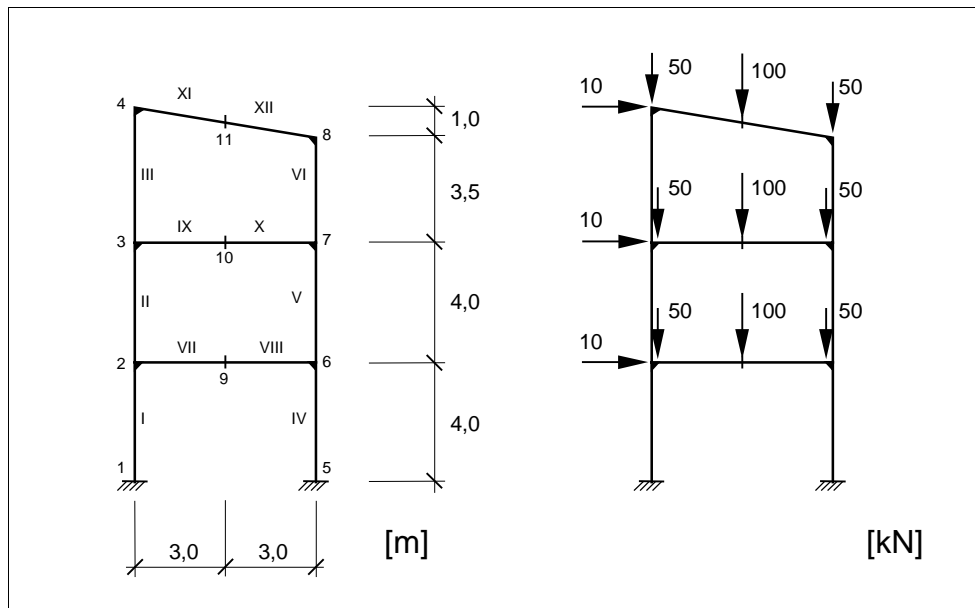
Stahlbetonrahmen – statisches System und Belastungsverteilung
